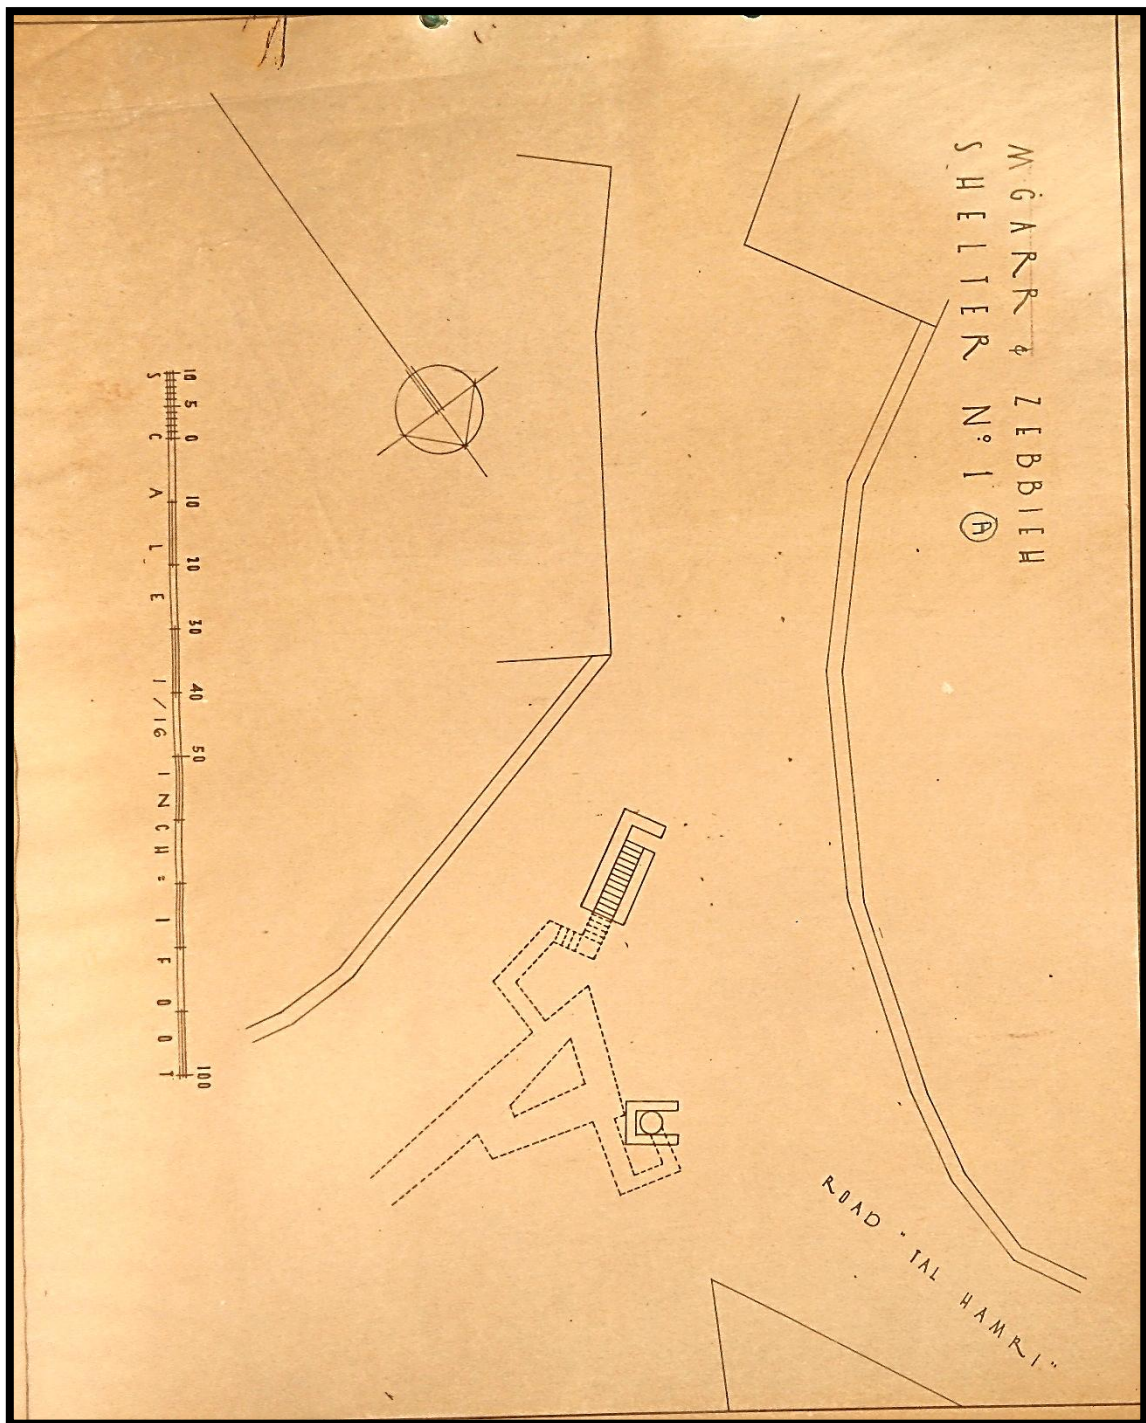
Planta do Abrigo nº1A "Road "Tal Hamri"
